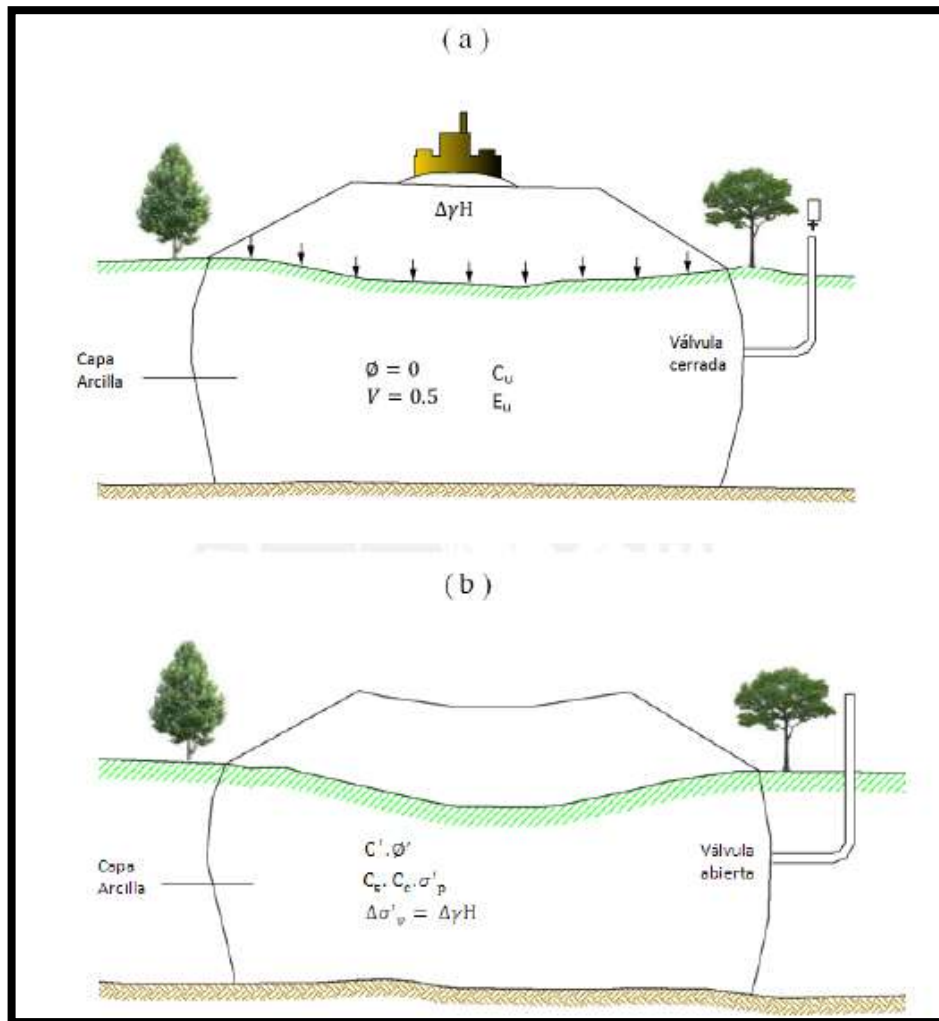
Proceso de consolidación. Fase (a): En construcción - Fase (b): A largo plazo
